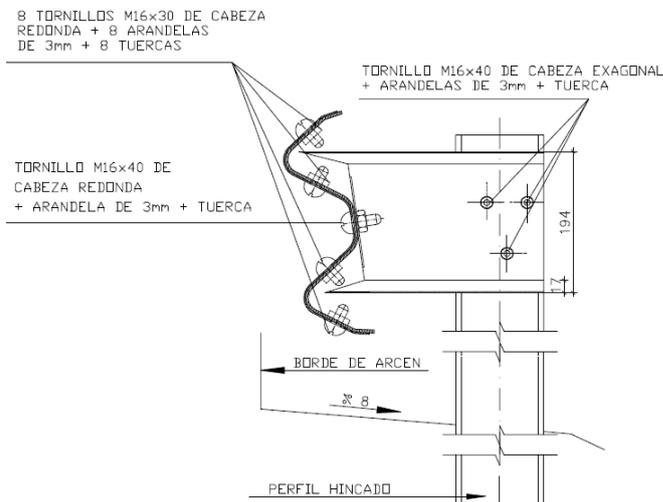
Detalle de elementos de sujeción de una barrera metálica simple
